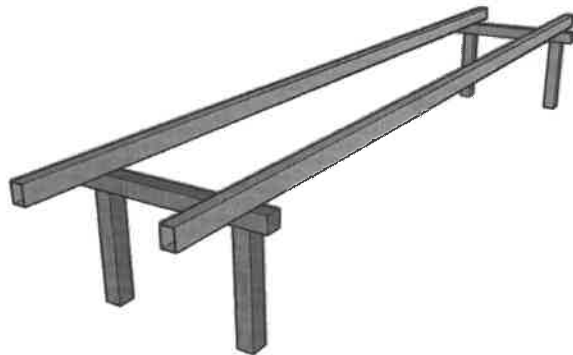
Схема укладки главных балок на монтажные поперечины
